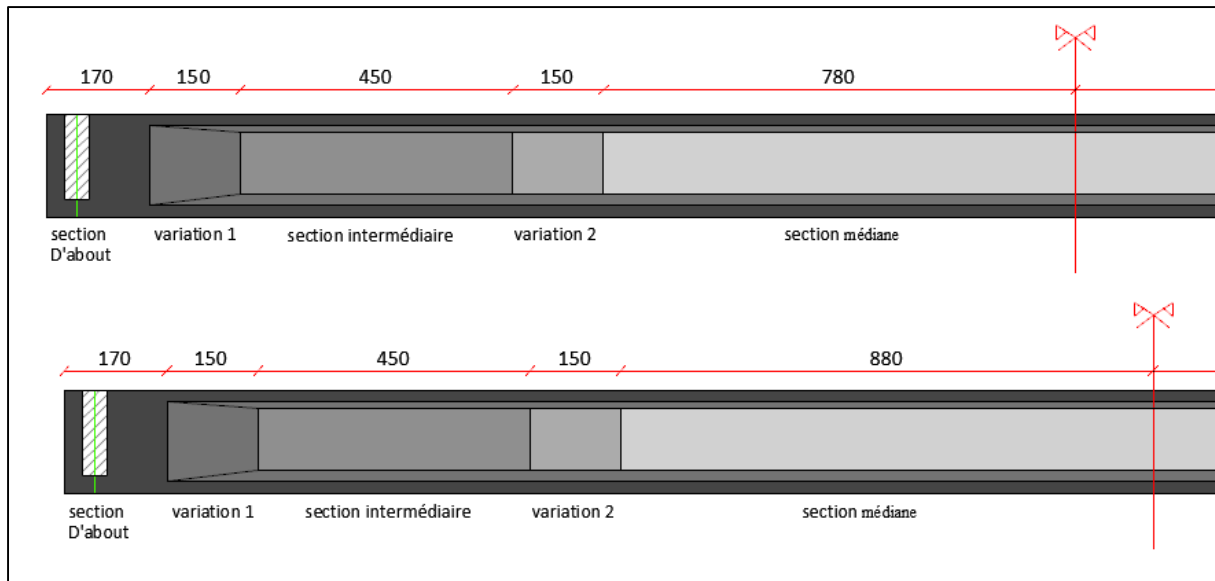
variation des section de la poutre type 35m et 33m variante (1)
